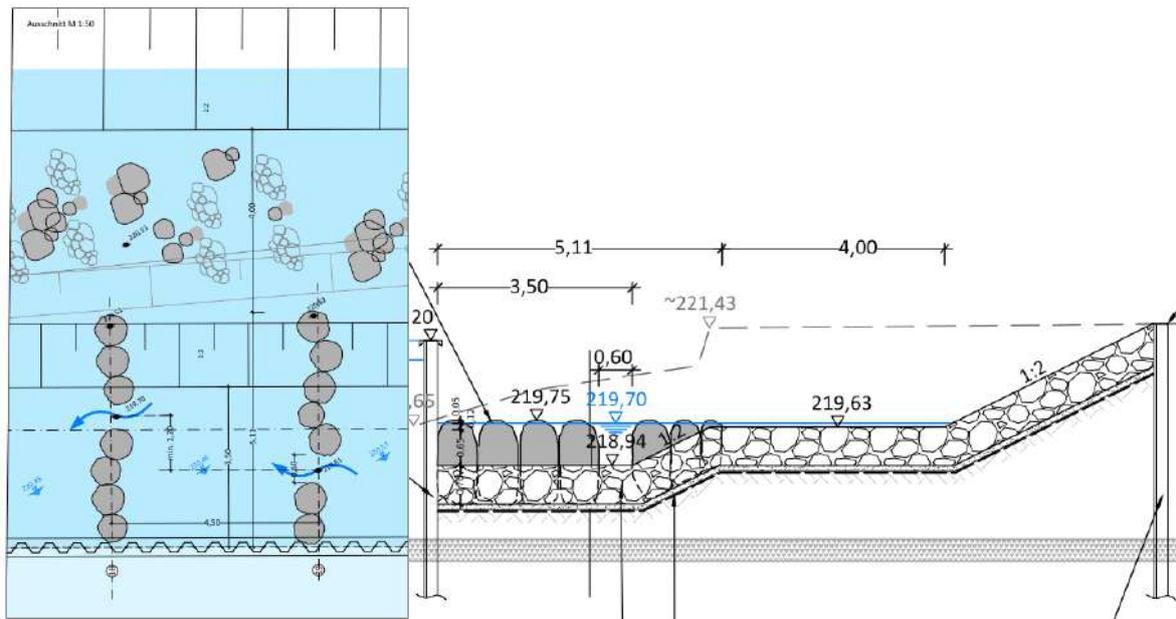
Ausschnitt Lageplan und Schnitt Fischaufstiegsanlage (Entwurfsplanung Hydro Energie Roth, April 2017)
